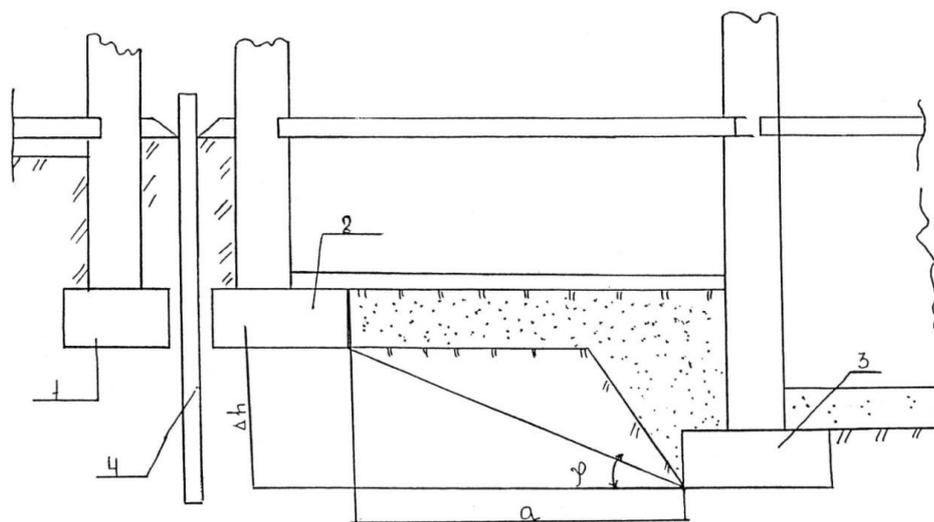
Схема фундамента с устройством шпунтовой стенки
